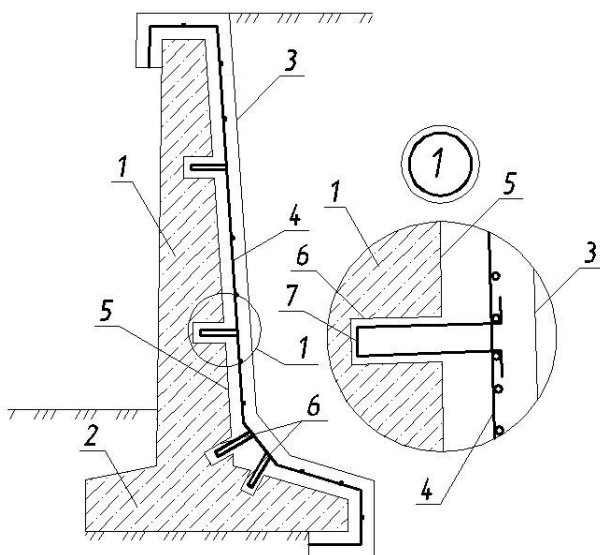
Улаштування залізобетонного нарощування при одночасному посиленні стіни й опорної плити: 1 – підпірна стінка; 2 – опорна плита стіни; 3 – залізобетонне нарощування в розтягнутій зоні; 4 – арматурна сітка; 5 – підготовлена до бетонування поверхня; 6 – ніші, що влаштовуються в стіні; 7 – гнуті арматурні стрижні
